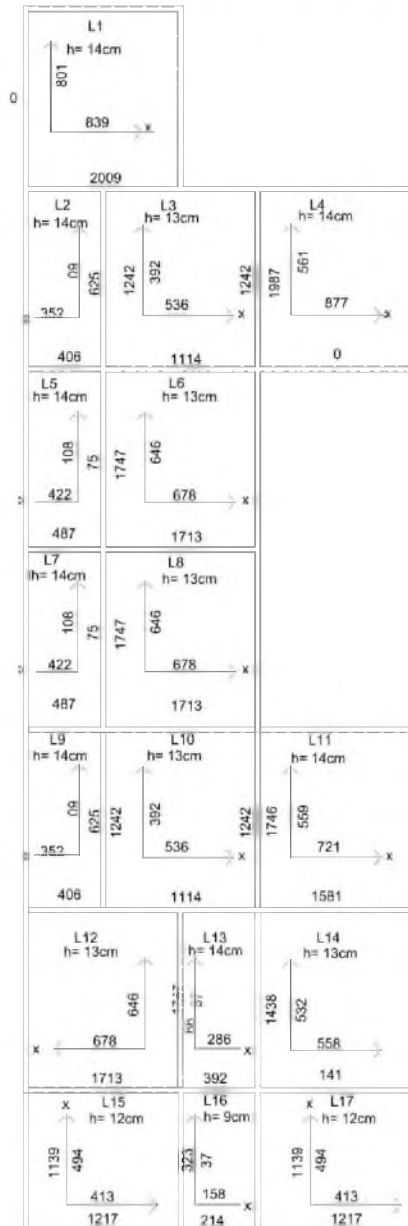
Momentos fletores característico (Mk - kN.cm /m) das lajes do primeiro pavimento
